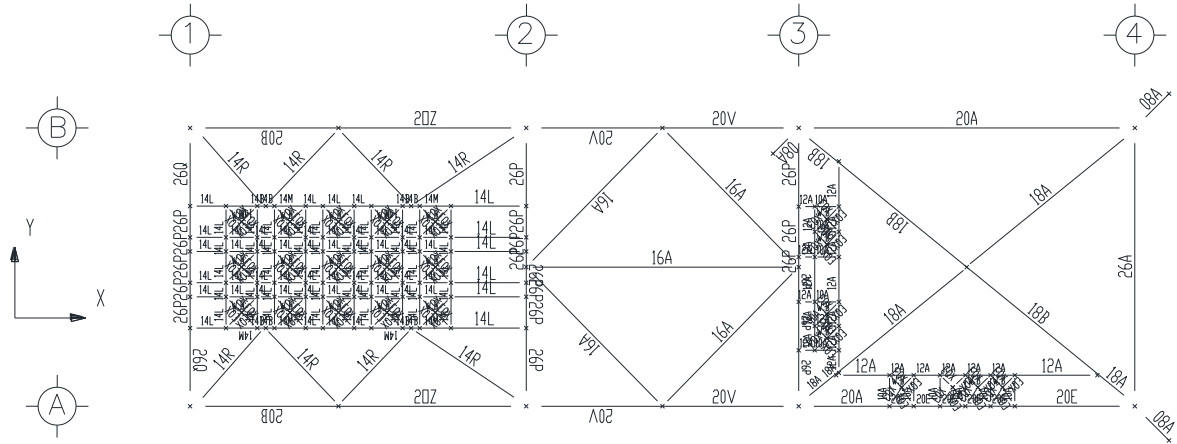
Grupos en Elev. (+) 6.096 m, subestructura
